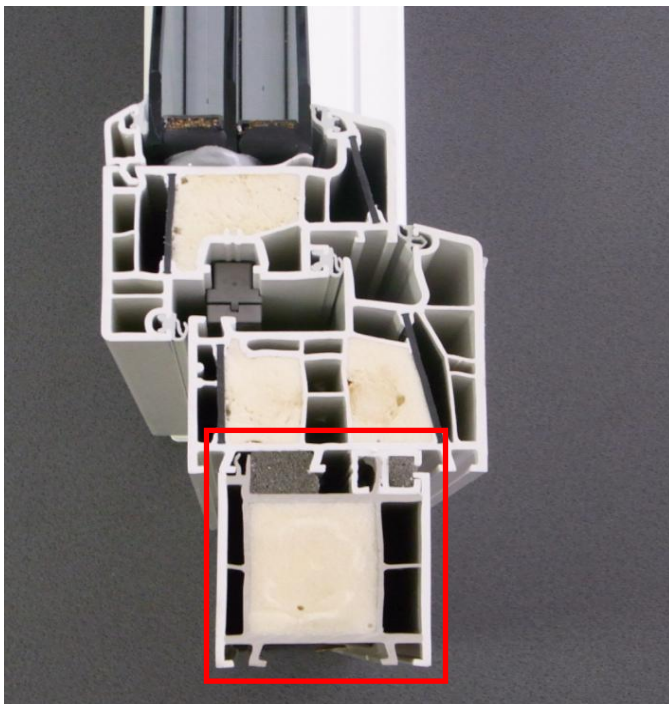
Beispiel für ein Fenster mit Fensterbankanschlußprofil (ausreichend hoch, eben und gedämmt)
